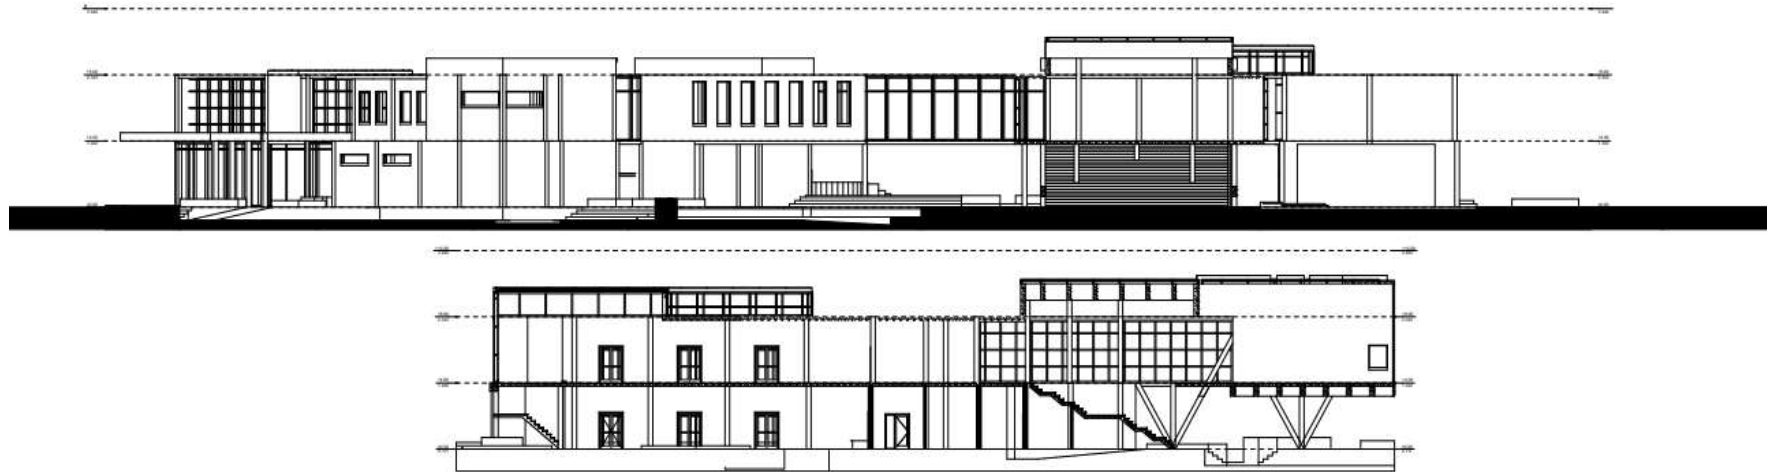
Vista - Cortes por Bloques – Bloque 1
